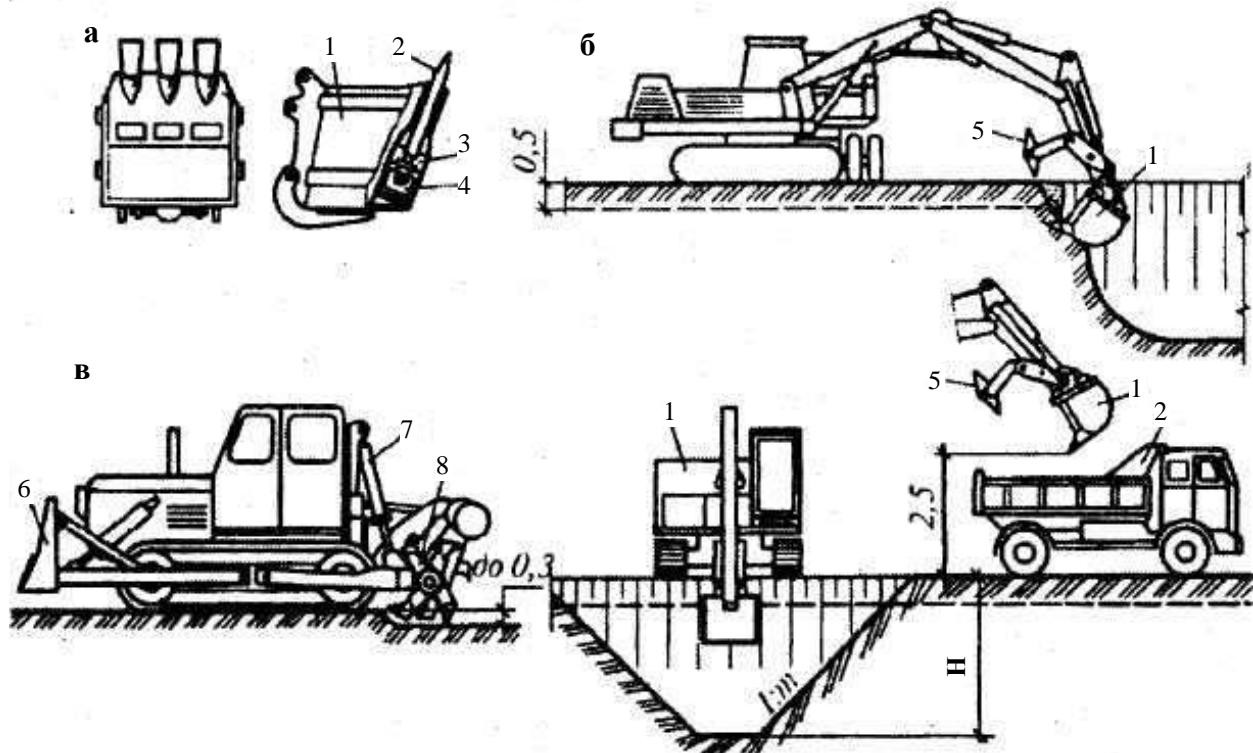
Механічний спосіб безпосереднього розроблення ґрунту: а – ківш екскаватора з активними зубцями; б – розроблення ґрунту за допомогою екскаватора «зворотна лопата» і захоплювально-кліщового пристрою; в – землерийно-фрезерна машина; 1 – ківш; 2 – зубець ковша; 3 – ударник; 4 – вібратор; 5 – захоплювально-кліщовий пристрій; 6 – відвал бульдозера; 7 – гідроциліндр для підмання та опускання робочої частини; 8 – робоча частина (фреза)
